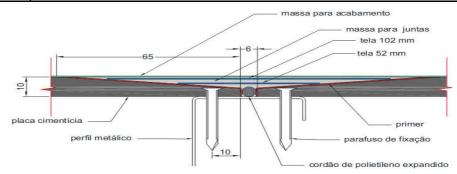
Esquema em corte transversal do tratamento de juntas entre placas cimenticias – face externa da parede
